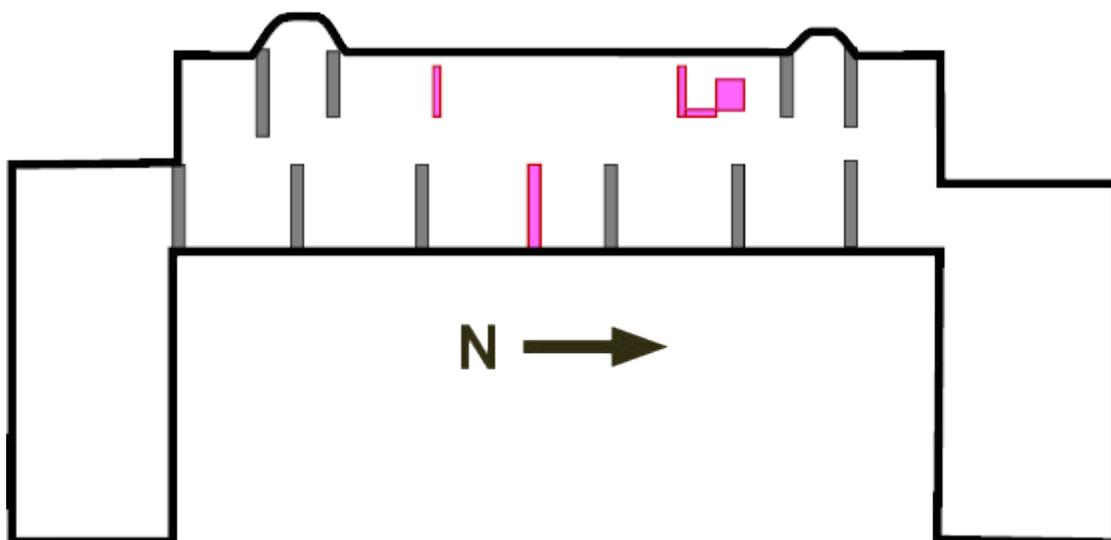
Concept 2 (en rose), vue en plan du rez-de-chaussée
